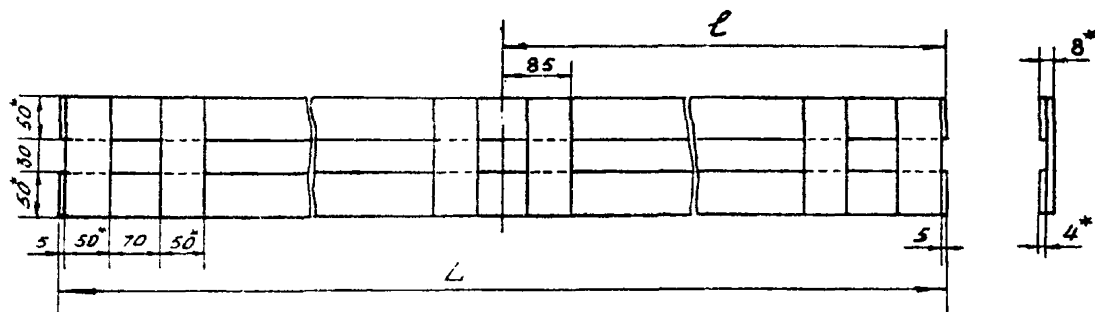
Мехрамная стяжка в виде сварного каркаса из полосовой стали
